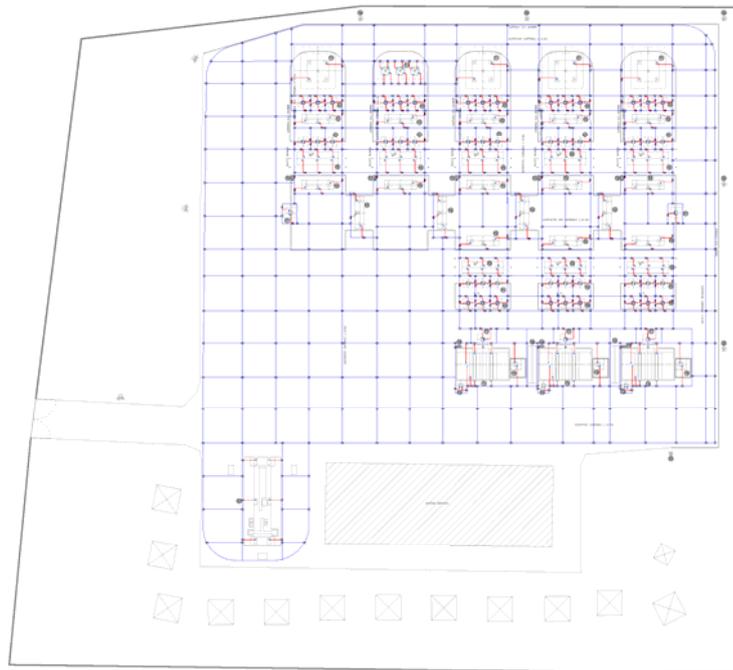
Stralcio planimetrico rete di terra cabina primaria Venosa
